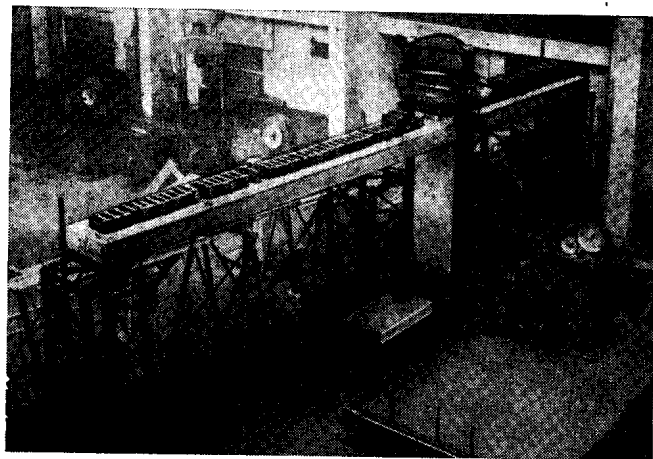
Испытание платформенного стыка с перекрытиями в натуральную величину
